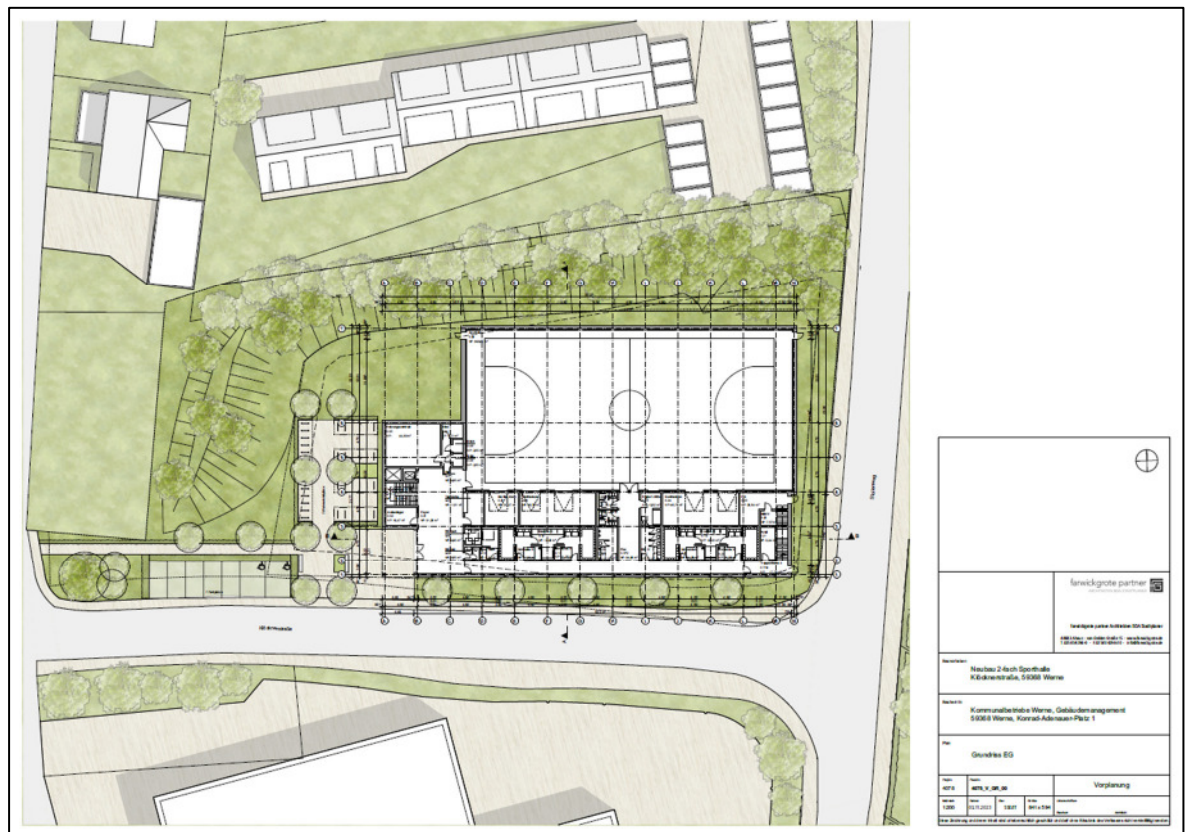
Vorplanung der geplanten Sporthalle im Stand vom 03.11.2023 [2], Grundriss Erdgeschoss
